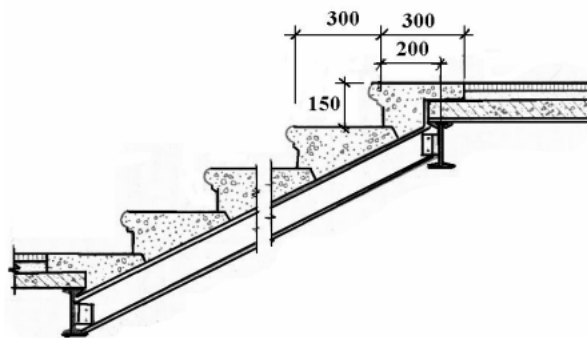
Конструктивне рішення дрібноелементних сходів (набірні залізобетонні щаблі укладені по сталевому косоуру, що спирається на двотаврову балку)
